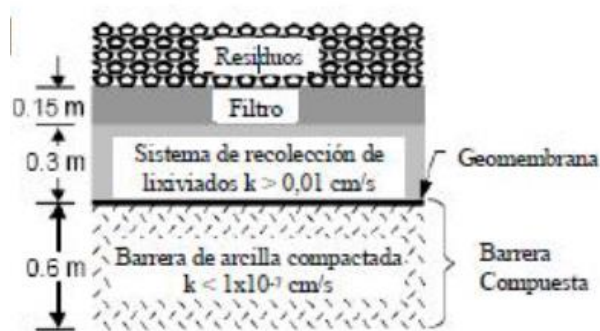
sistema de impermeabilización de fondo. EPA (1993)
